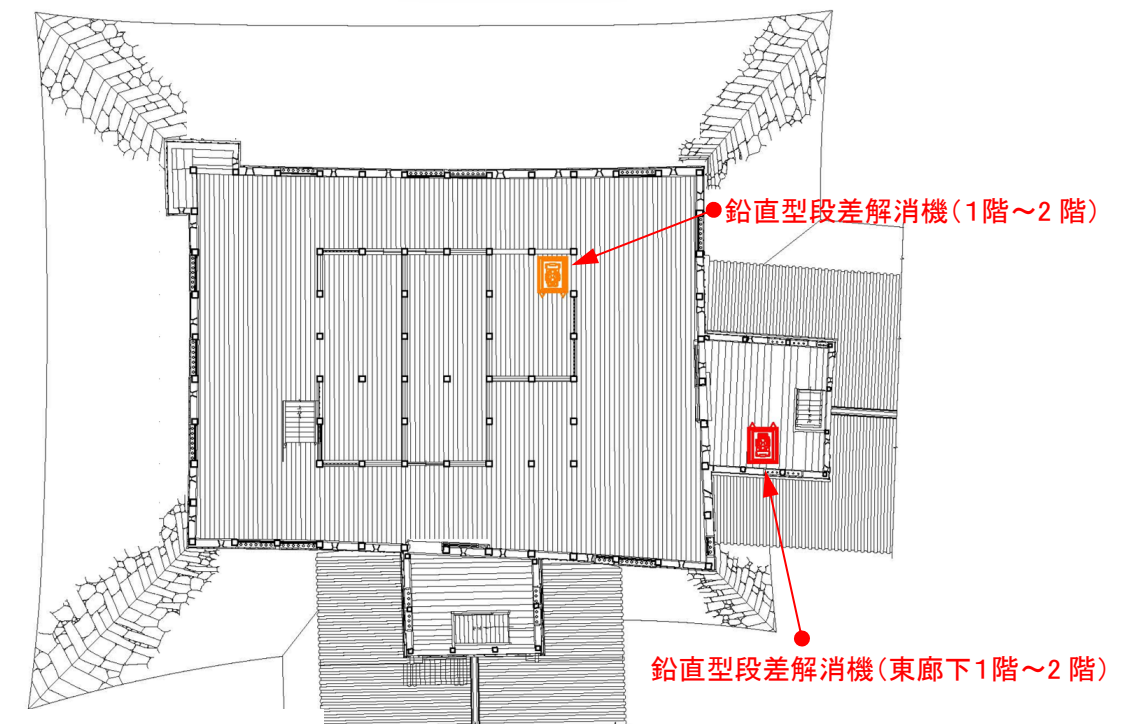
天守1階平面図及び東廊下・南廊下2階平面図（復元原案）
